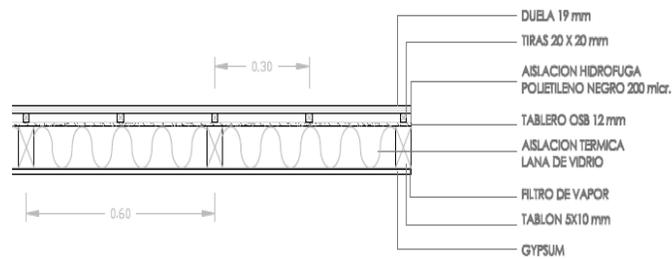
Tipología de entrepiso con barrera acústica en madera.
